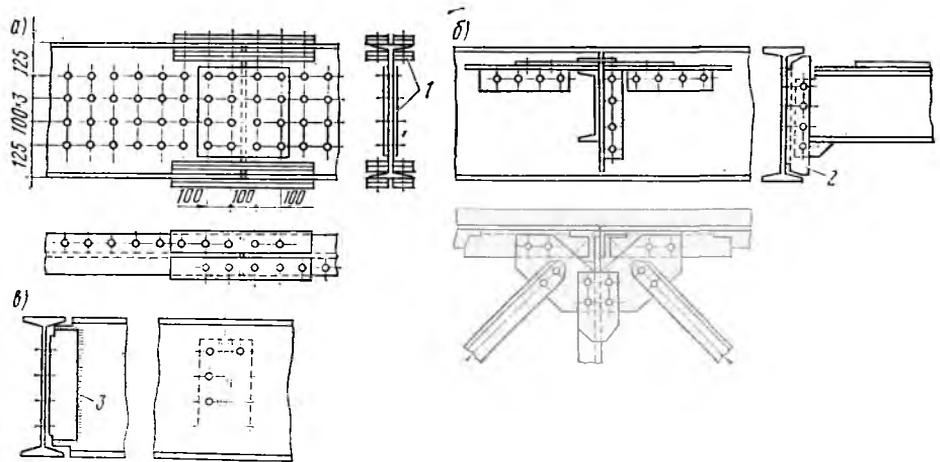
Узлы балочных конструкций из УИКМ:
